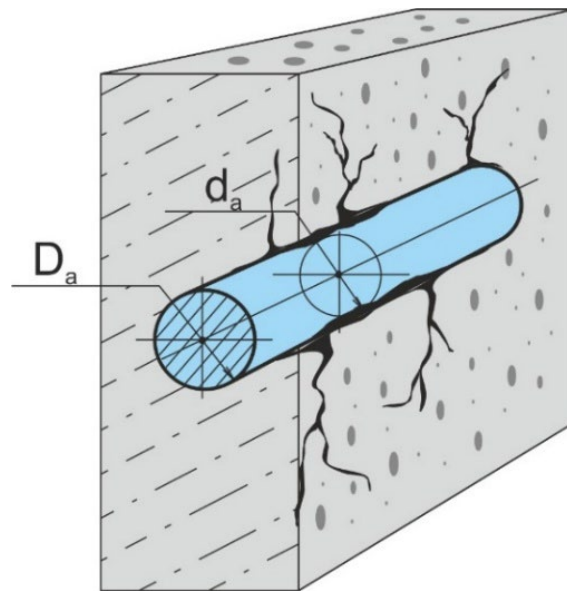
Схематичне зображення тріщиноутворення в залізобетоні внаслідок корозійних впливів на металеву арматуру:
